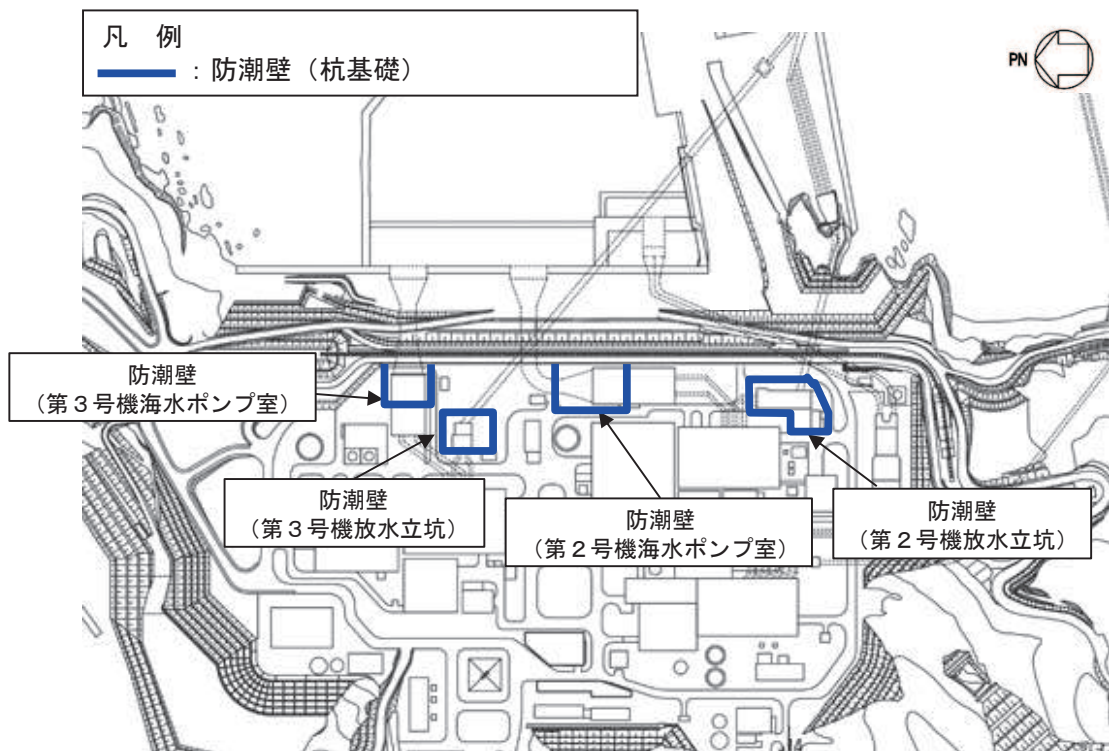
防潮壁（杭基礎）の平面配置図
